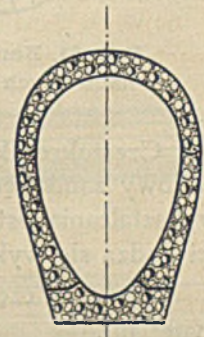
Rura żelbetowa kanalizacji Leningradu dla głębokości 6,0 m.
